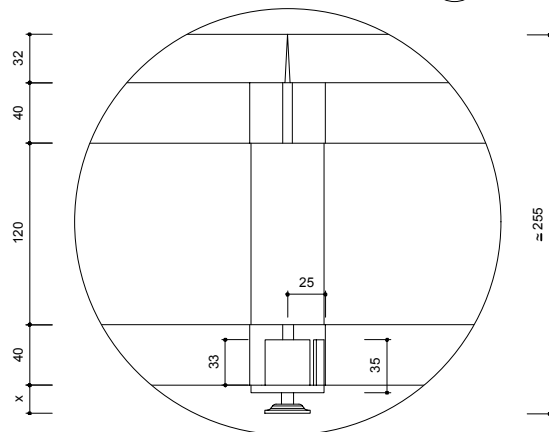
Maqueta de sistema de pavimento sobrelevado para espaço de exposição. Pormenor de esquadrias de ligação. Registo de Salomé Arieira.
